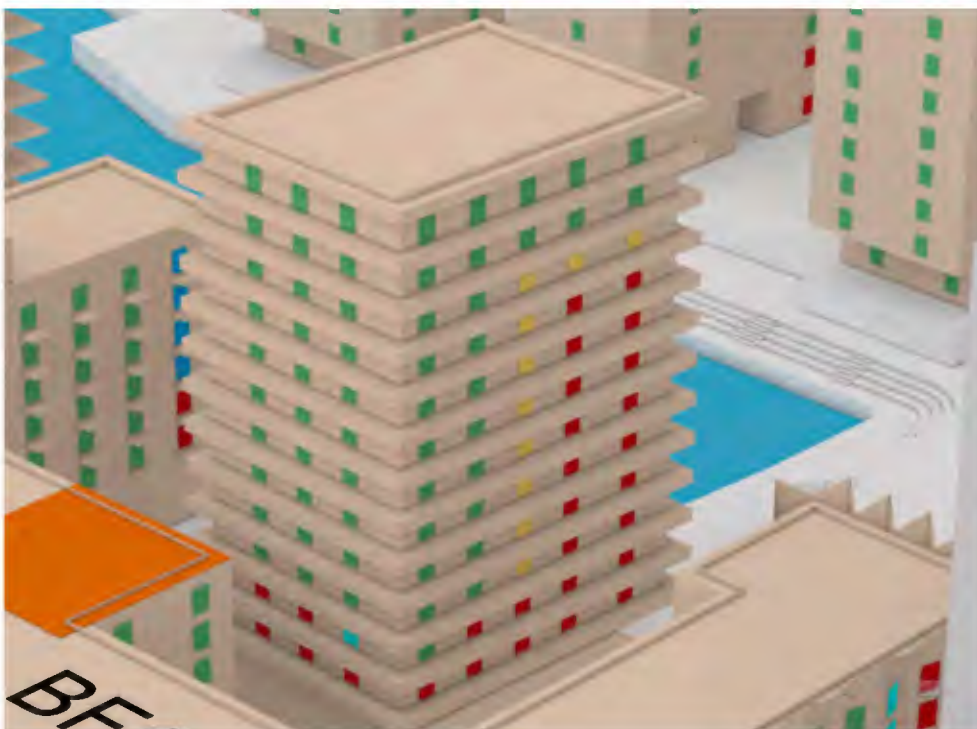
Baufeld 115- Ostfassade und Südfassade - Maßnahmenempfehlungen
